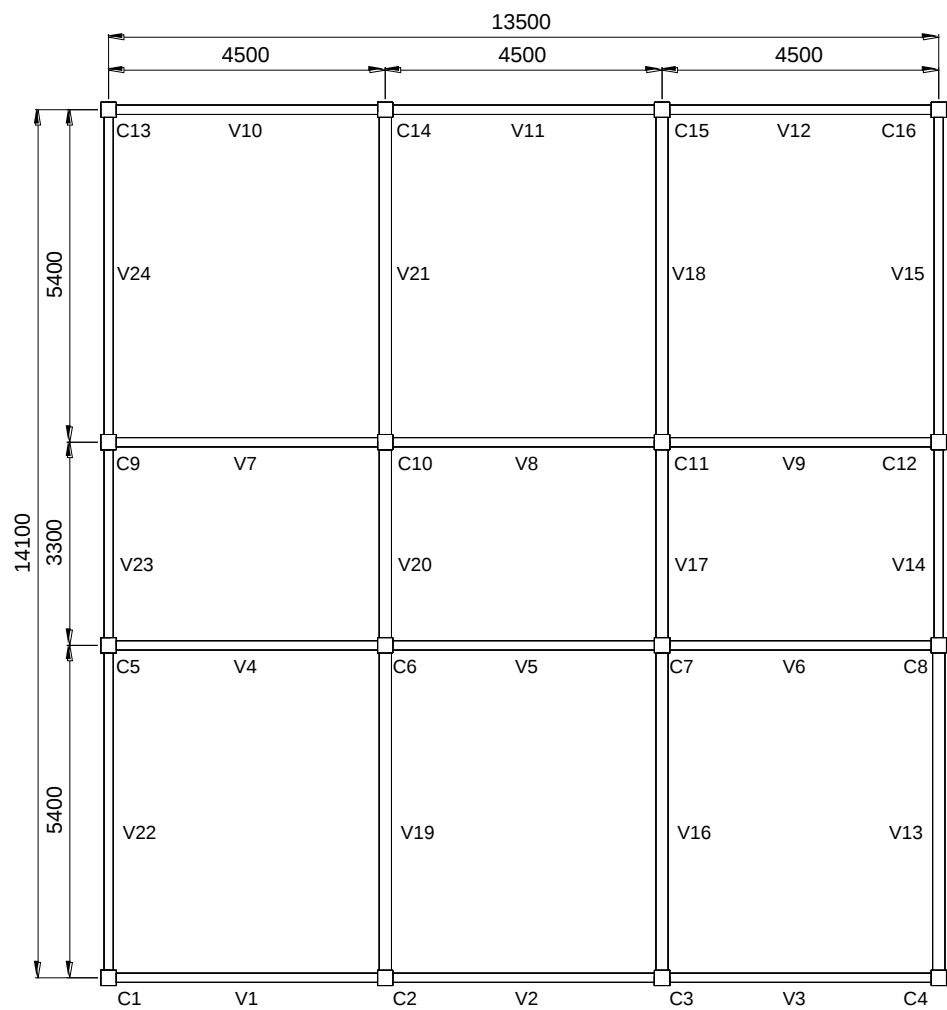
7 Disposición estructural de vigas y columnas del piso 2
